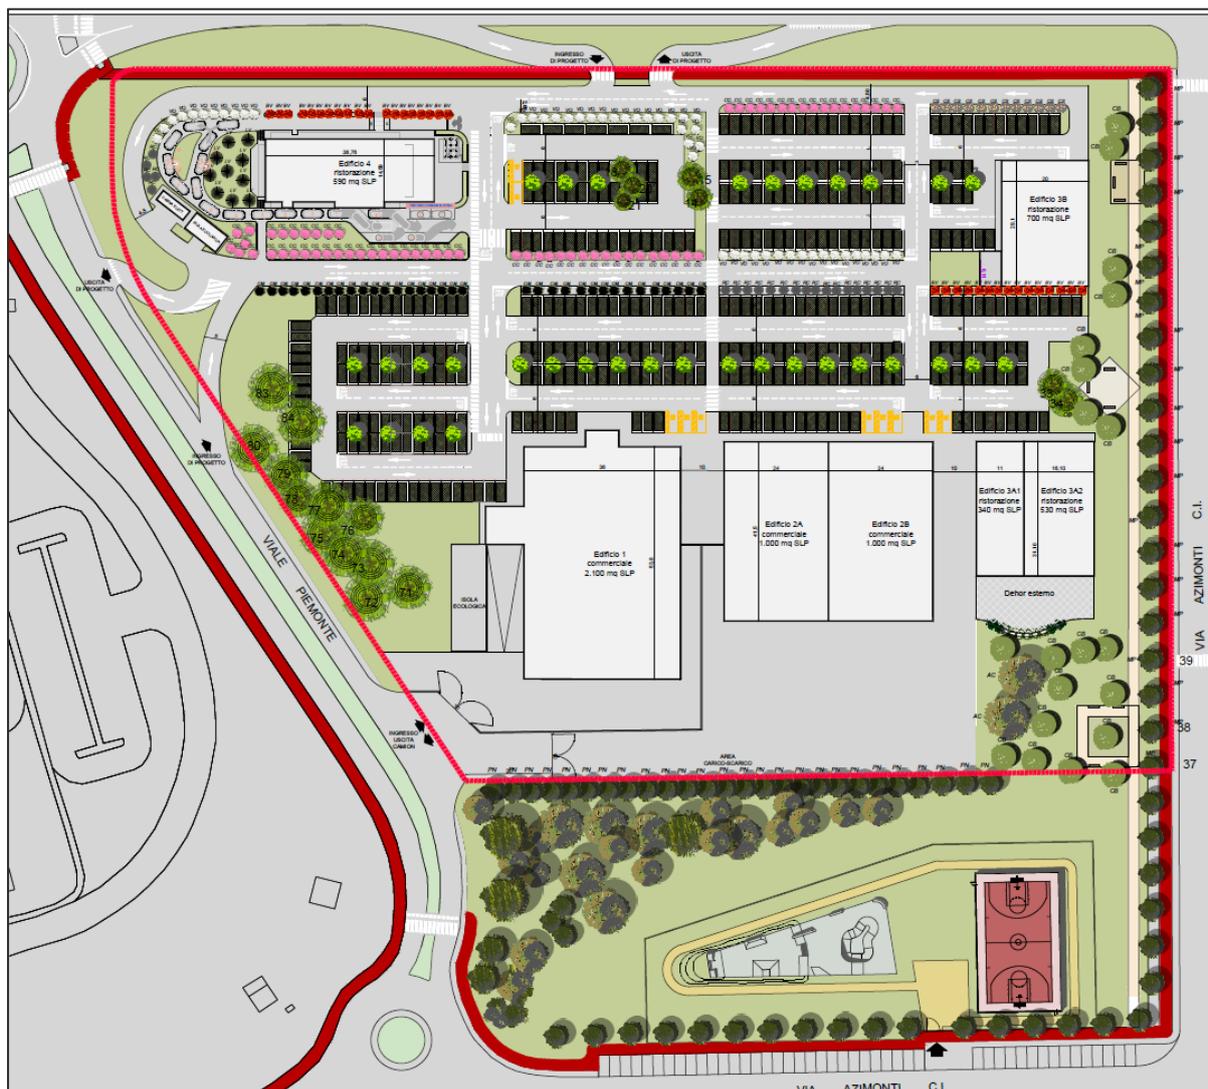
Planimetria generale dell'assetto vegetazionale in progetto
